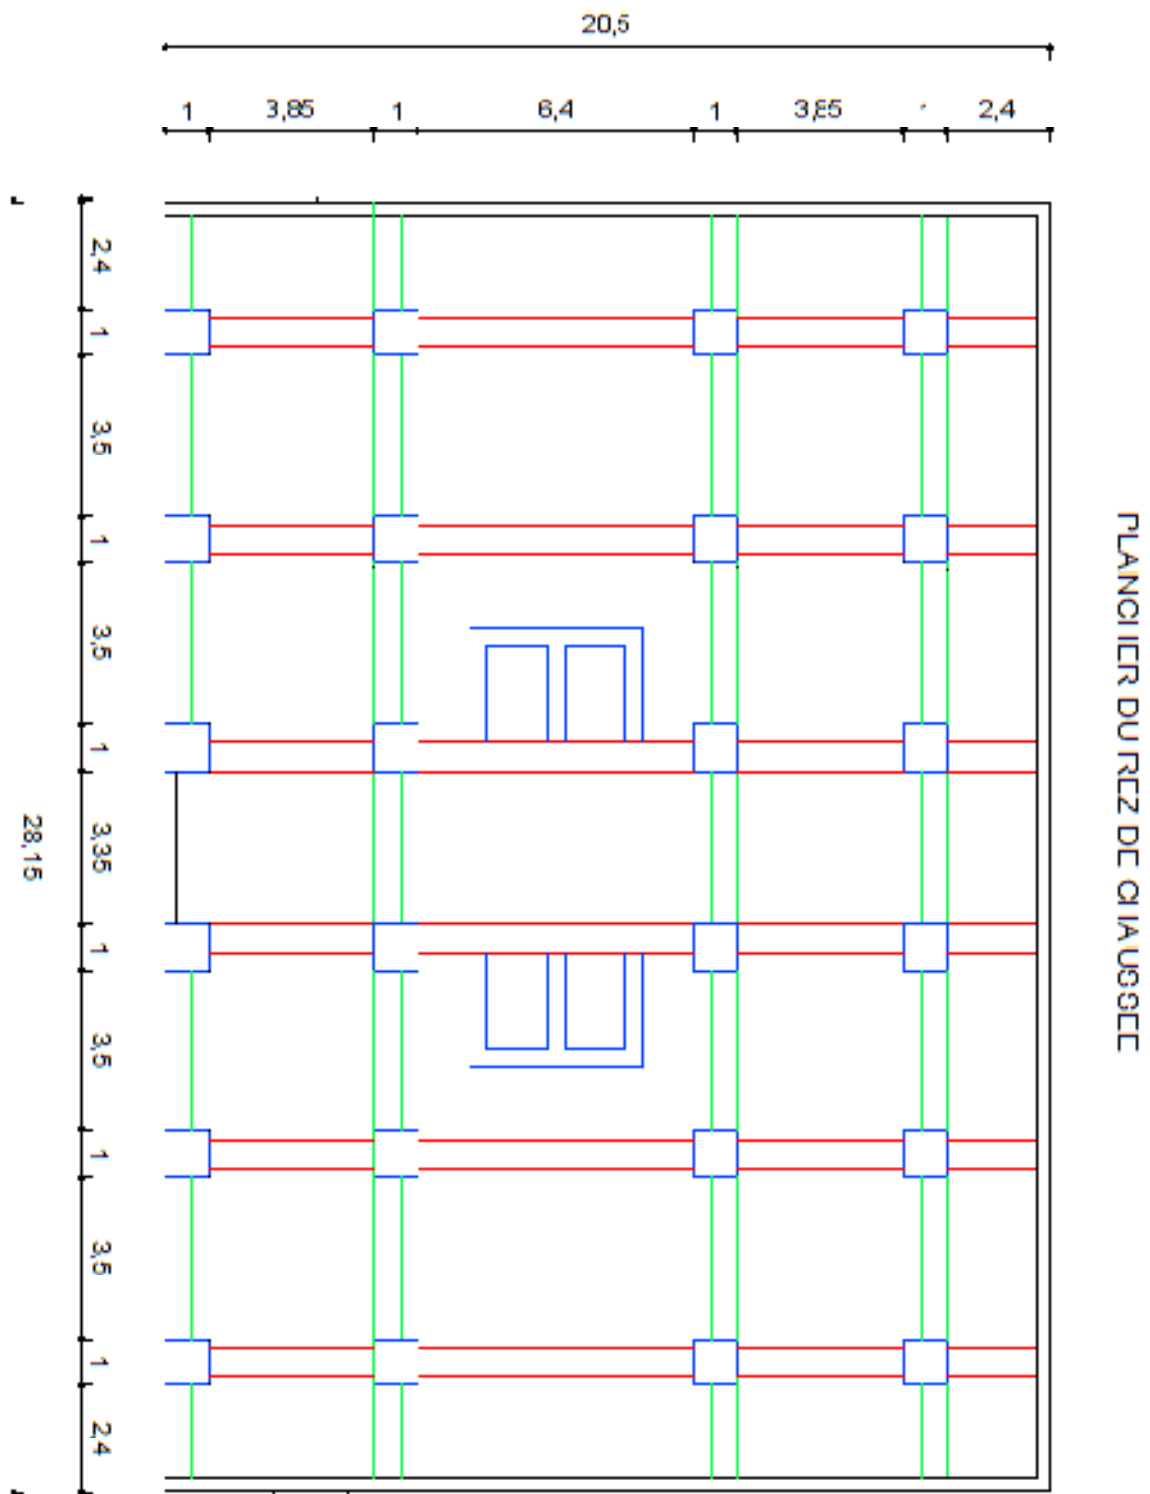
Vue en plan du plancher du rez-de-chaussée des deux tours. Le rouge représente les poutres transversale , le bleu représente les poteux et les voiles et le vert représente les poutres longitudinale.
